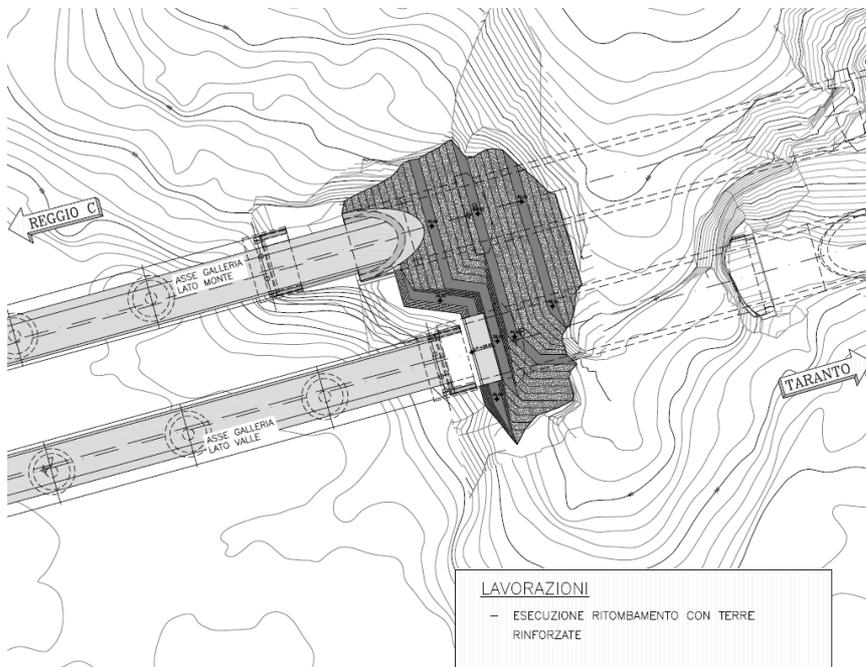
Galleria Ambusena-sistemazione finale – Lato RC
